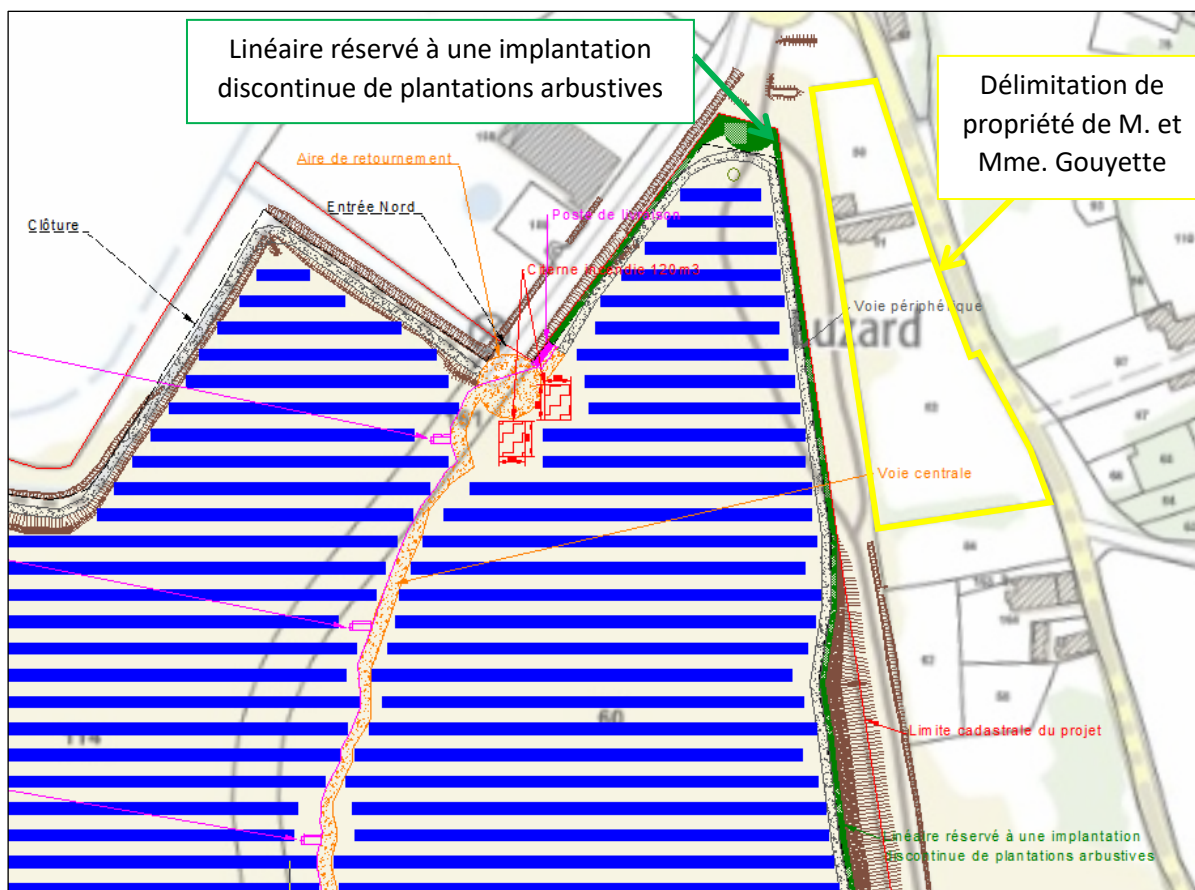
Localisation de l'implantation des plantations arbustives et de la propriété de M. et Mme. Gouyette – extrait du plan d'implantation du permis de construire
